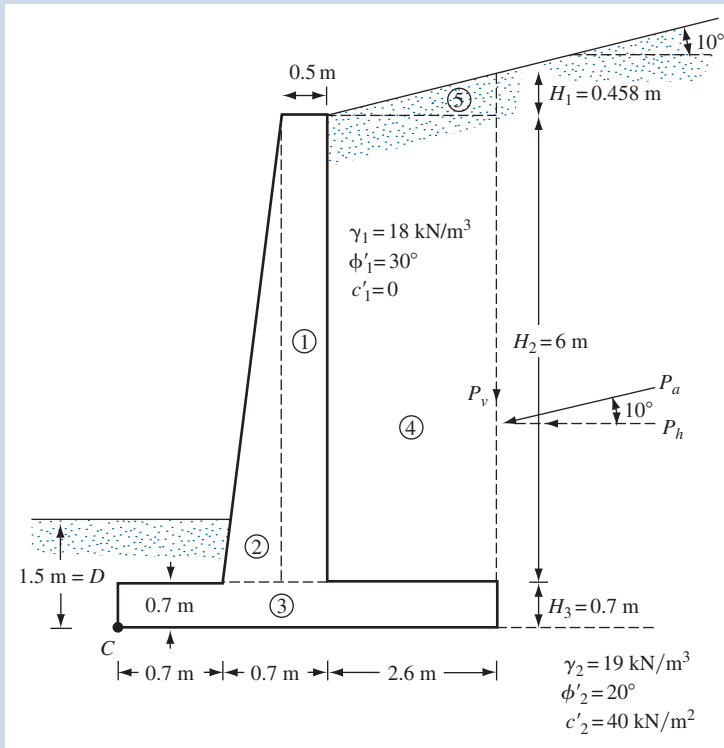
Cálculo de la estabilidad de un muro de retención.
